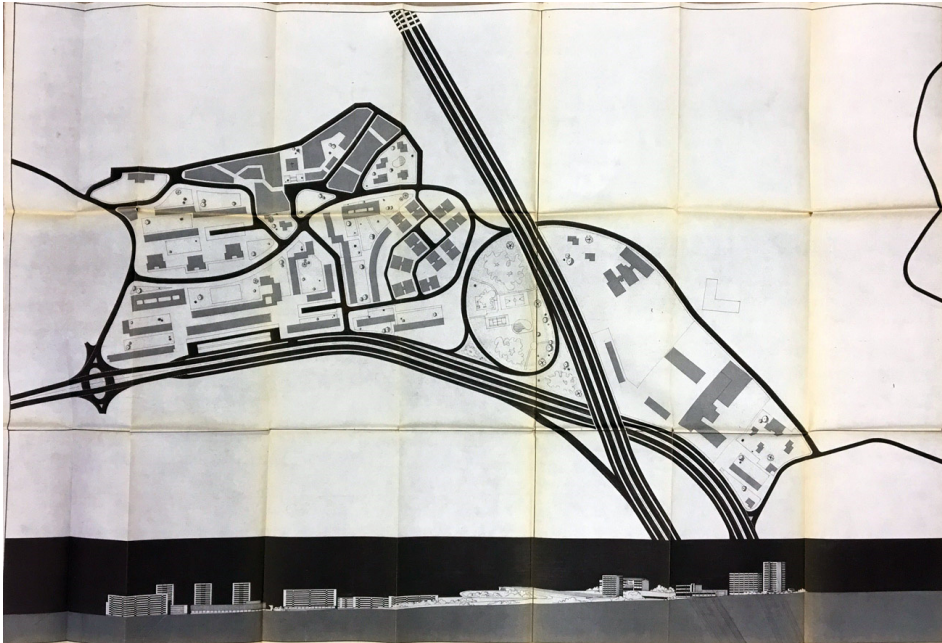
Plano General Plan Parcial de Palavea. Fuente: Archivo General de Fomento.
